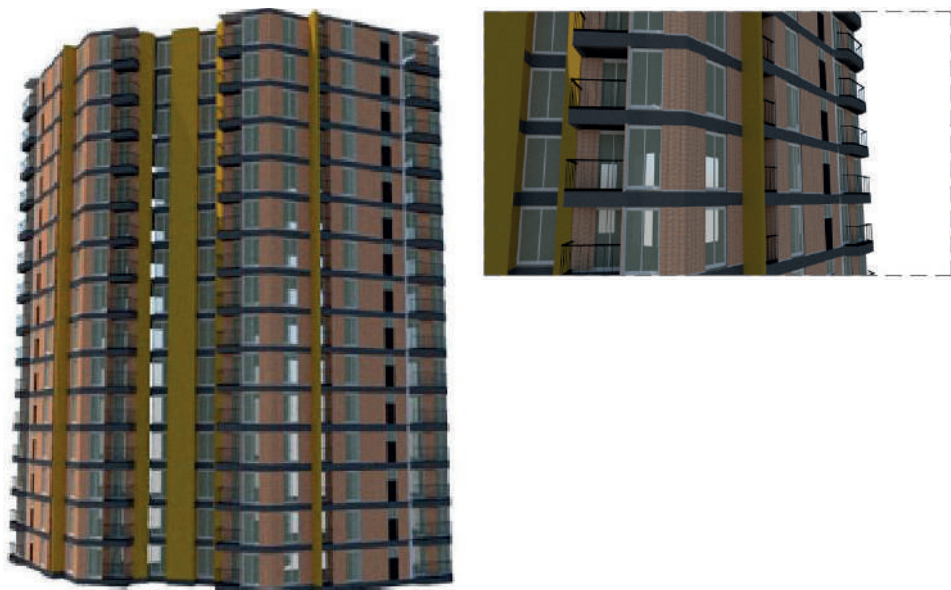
Projeto em 3D da composição da fachada. Acervo do Autor
